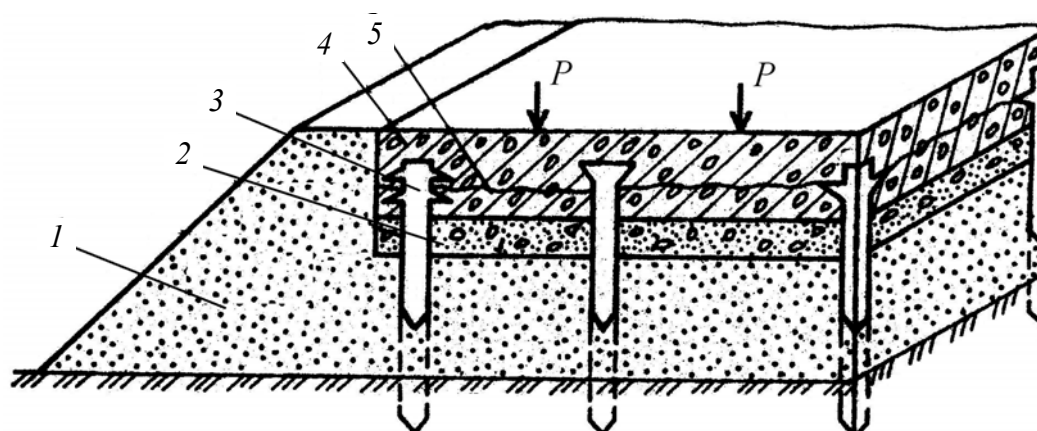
Разрез дорожной конструкции с вертикальными сваями:
